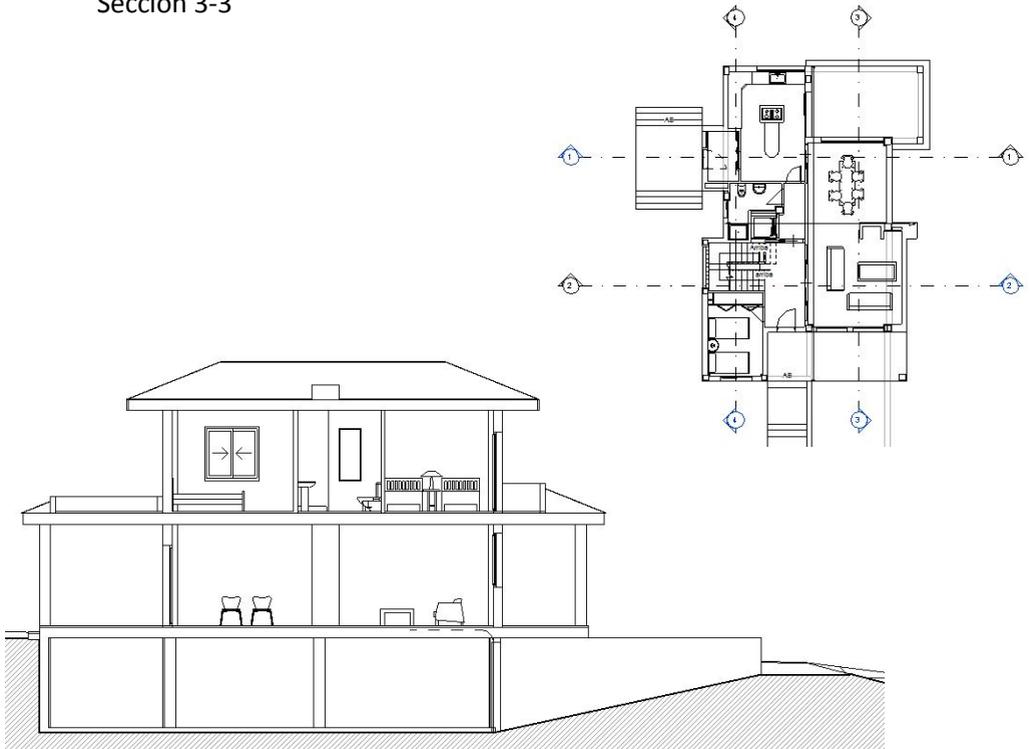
Sección 3 - 3' . Fuente propia Revit
